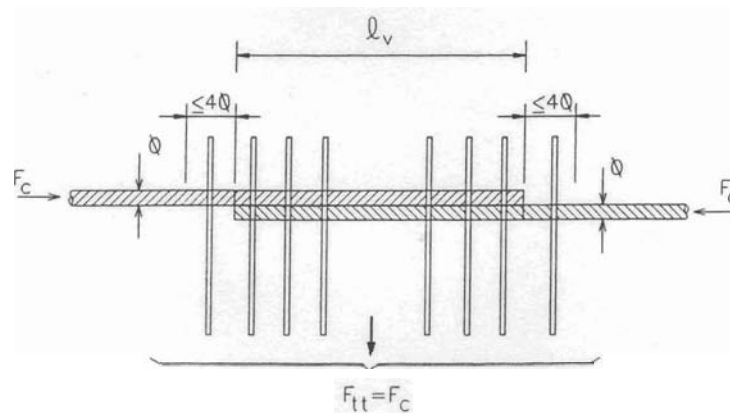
Arranjos de estribos para barras comprimidas emendadas [FUSCO, 1994]
